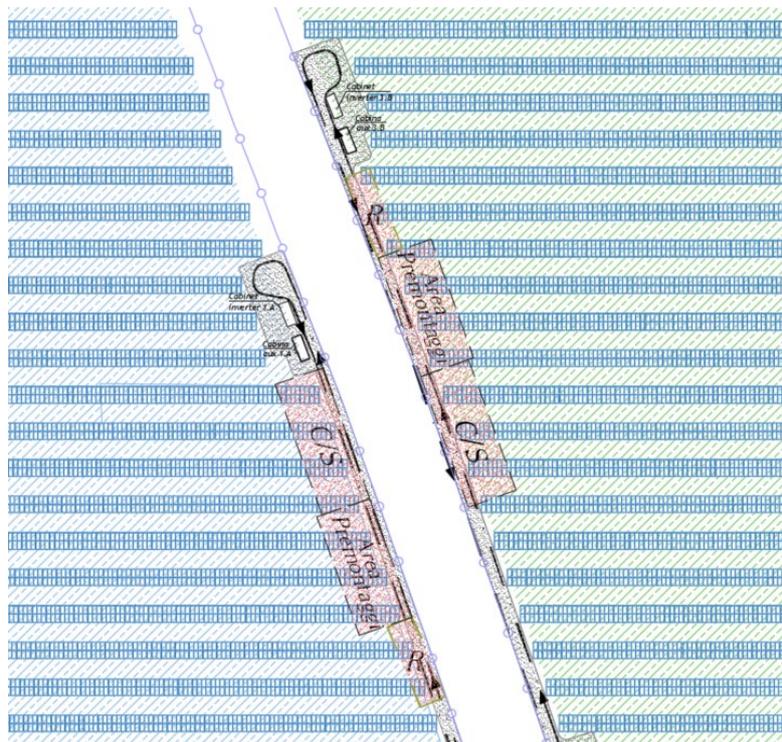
dettaglio aree di cantiere “Chions 1” a sinistra e “Chions 3” a destra
